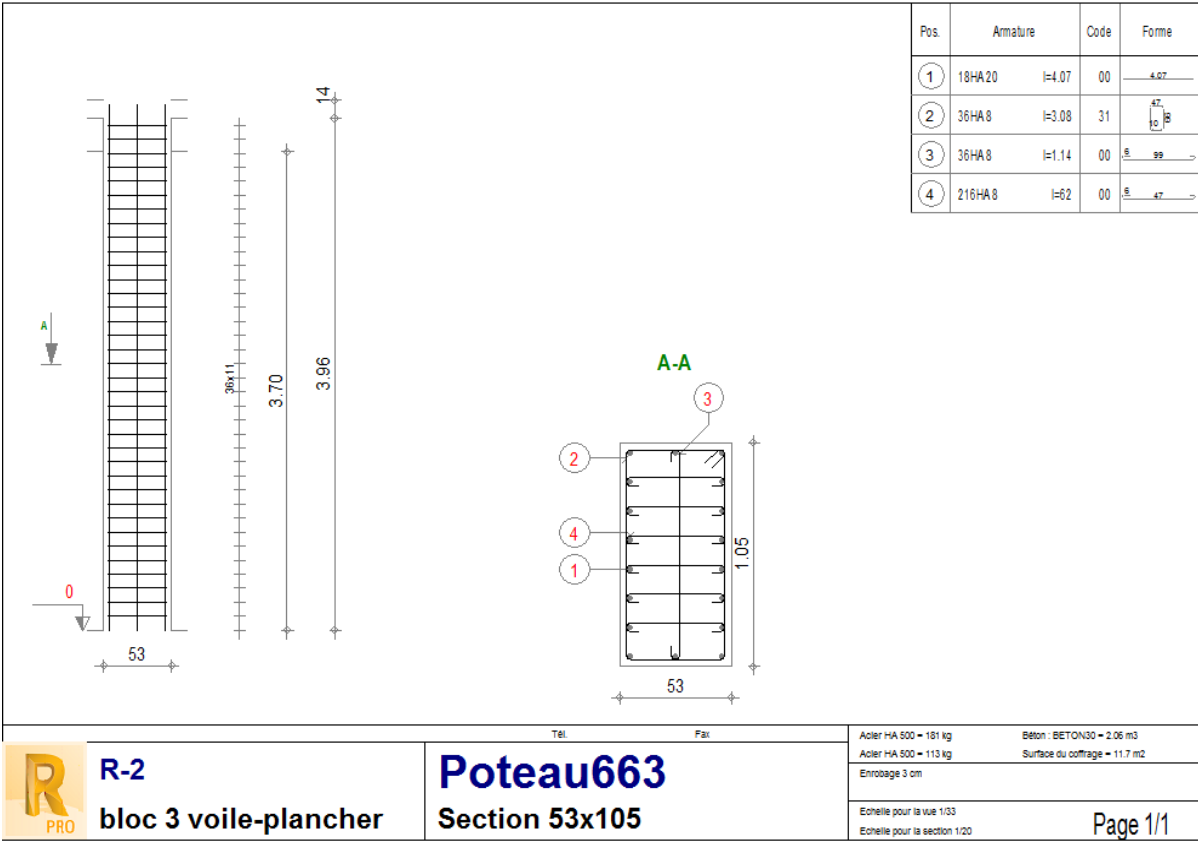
Ferrailage des Poteaux P60 et P61 (R-2)
